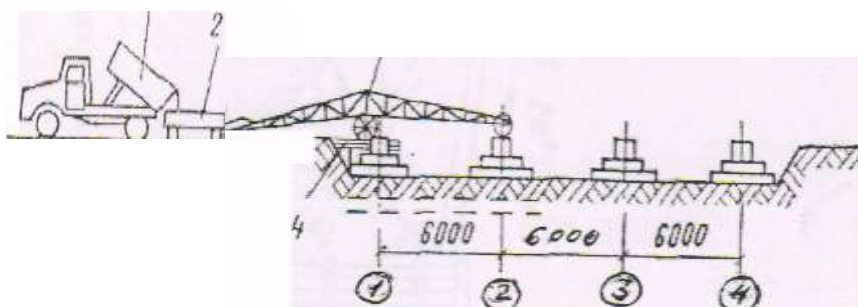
Схемы бетонирования фундаментов с помощью ленточного конвейера
